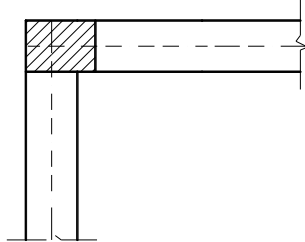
Arranjo estrutural do pilar na planta de fôrma e dimensões da seção transversal.
